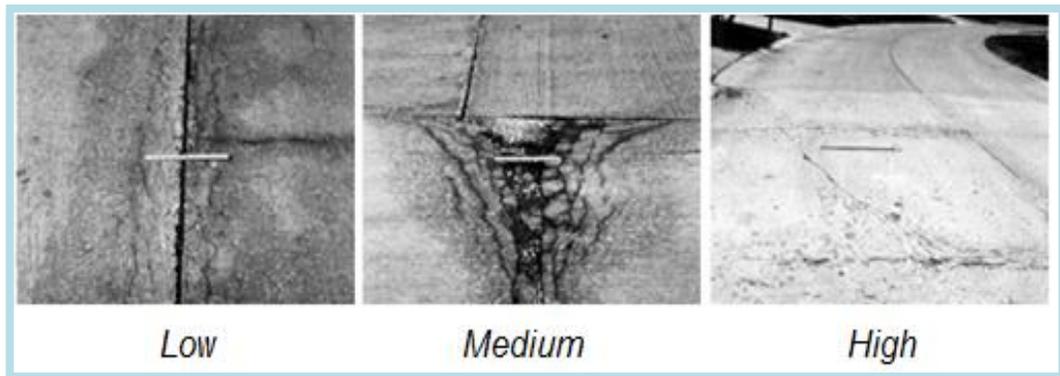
Tingkat Kerusakan Slab Terbagi oleh Retak (*Divided Slab*)
